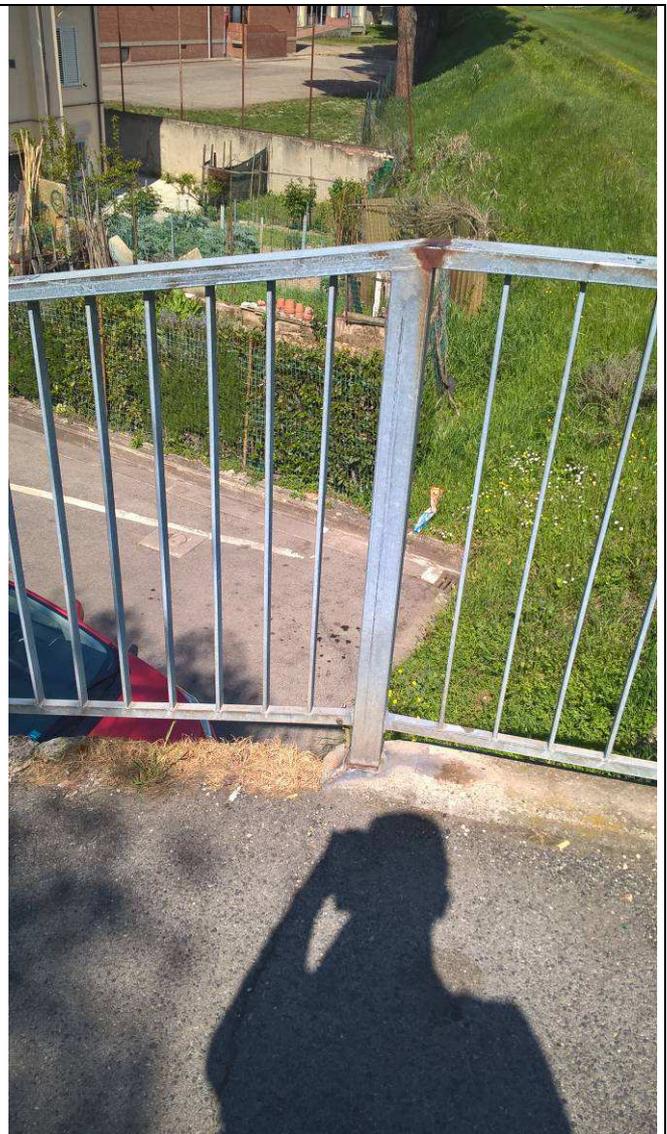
Vista del montante ancorato all'estremità della trave di impalcato sul lato di via Trento (montante a comune con il campo di balaustra della rampa, lato monte)
